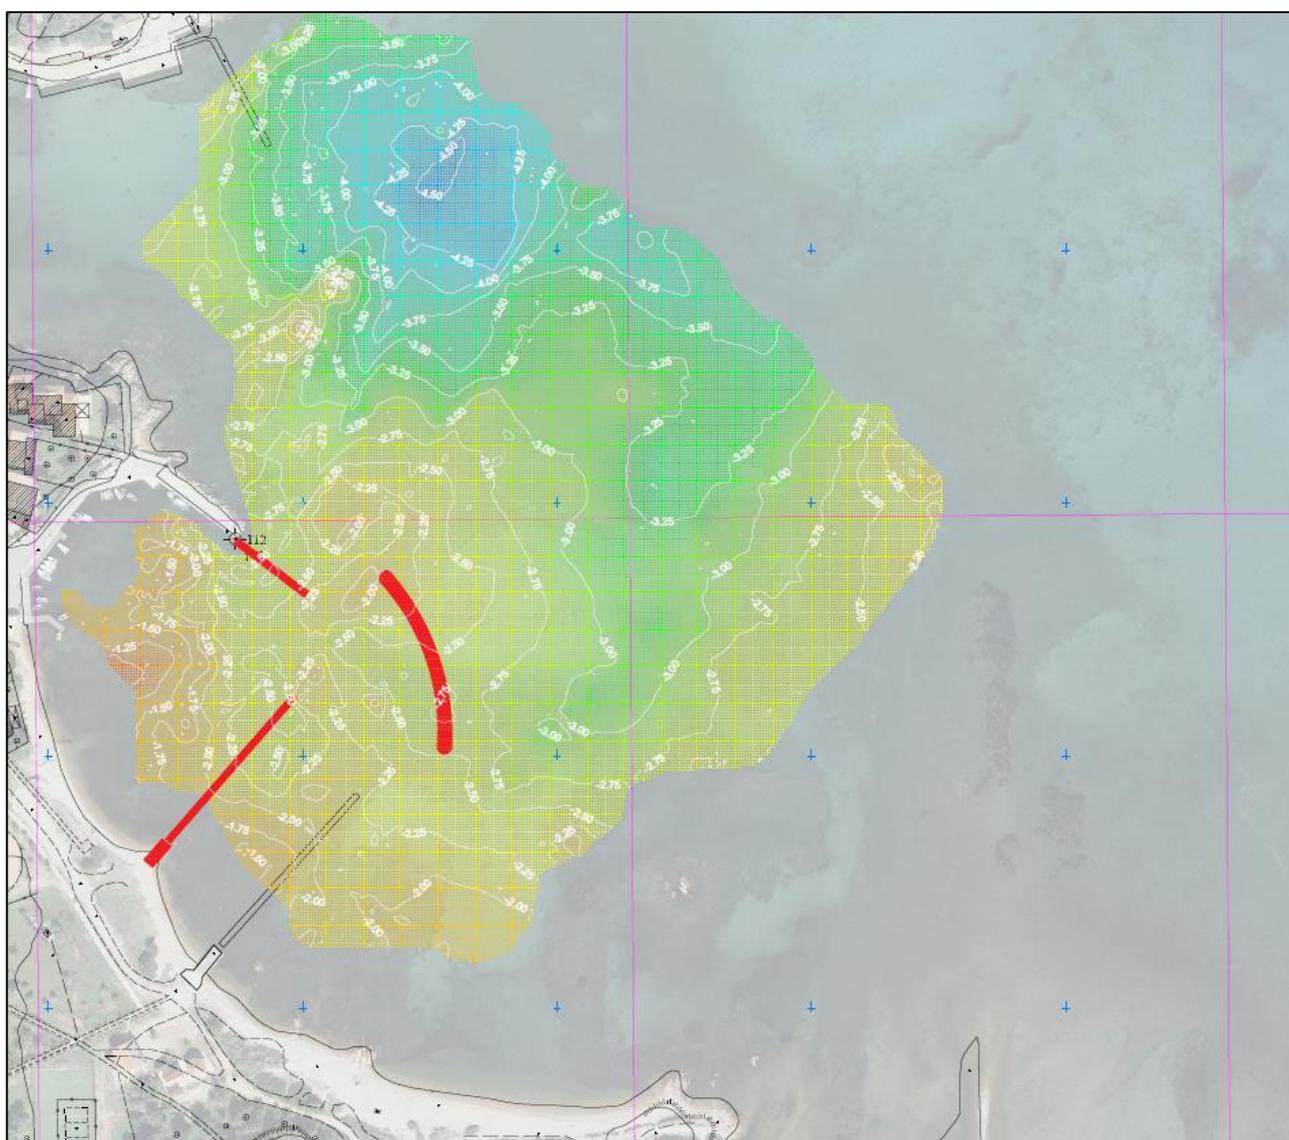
planimetria situazione attuale con indicazione opere in progetto su base Batimetrica
